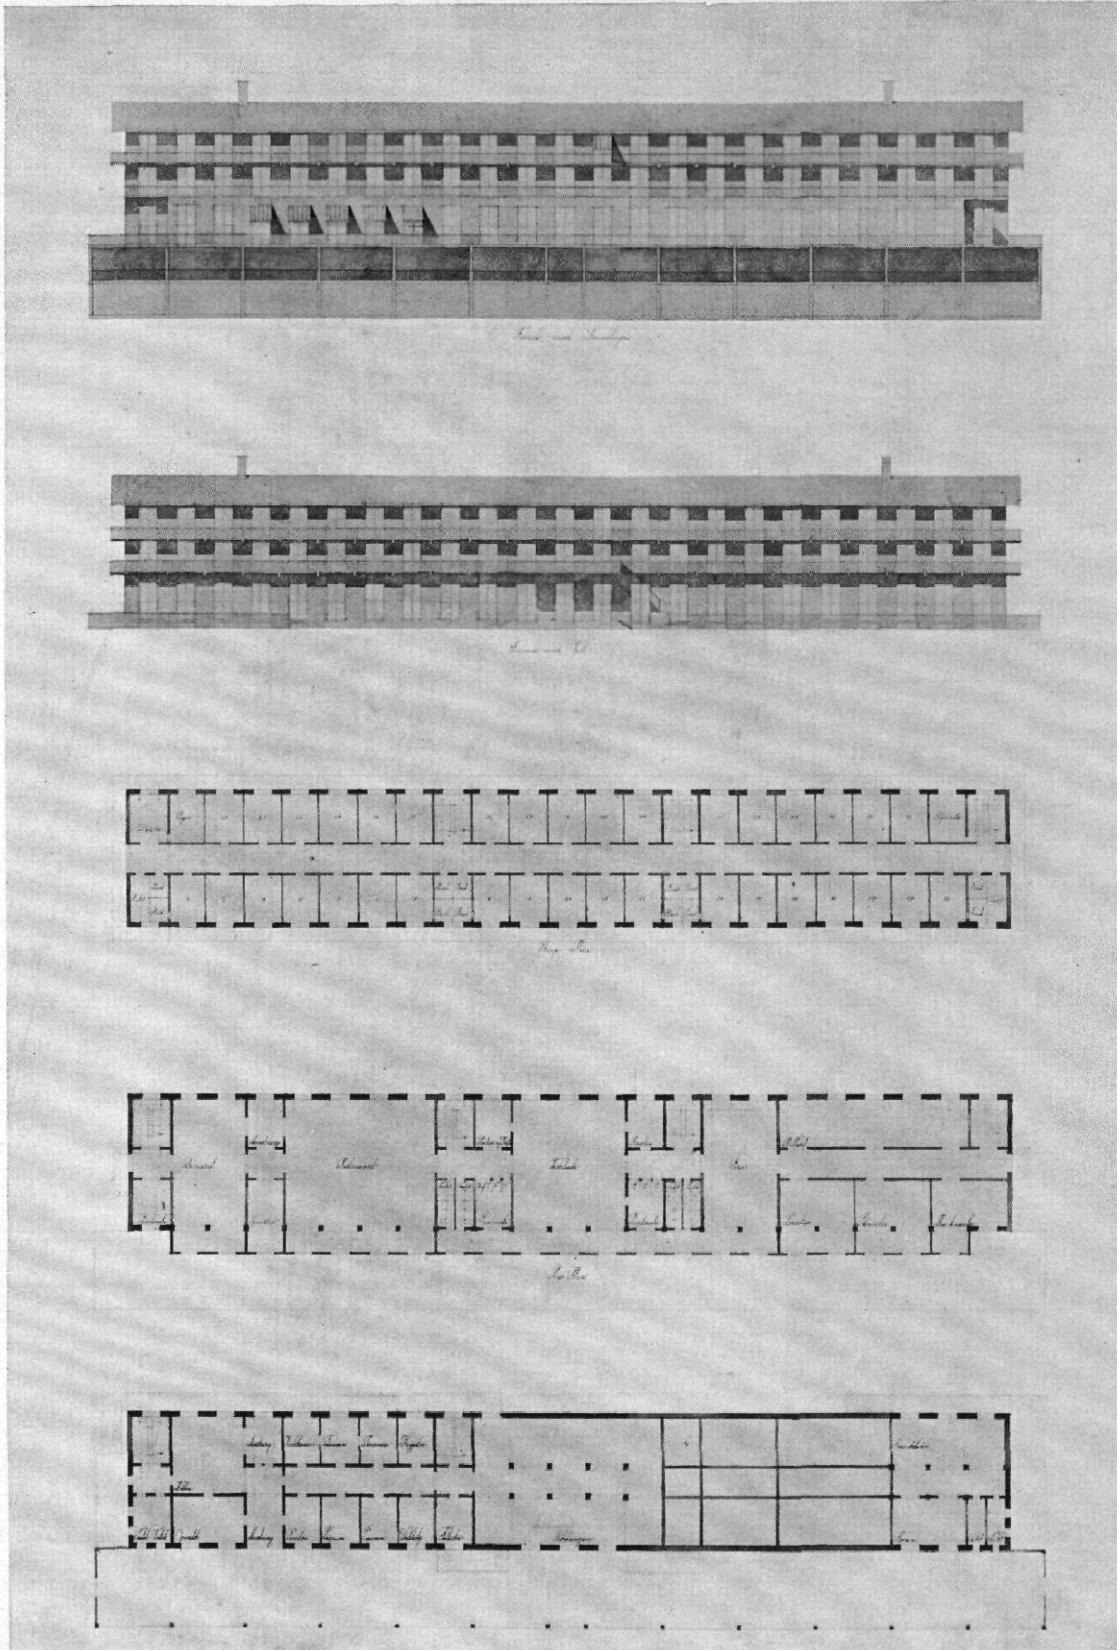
bis 10 / Entwurf zu einem Badehotel / Ansichten und Grundrisse im Maßstab 1:800
